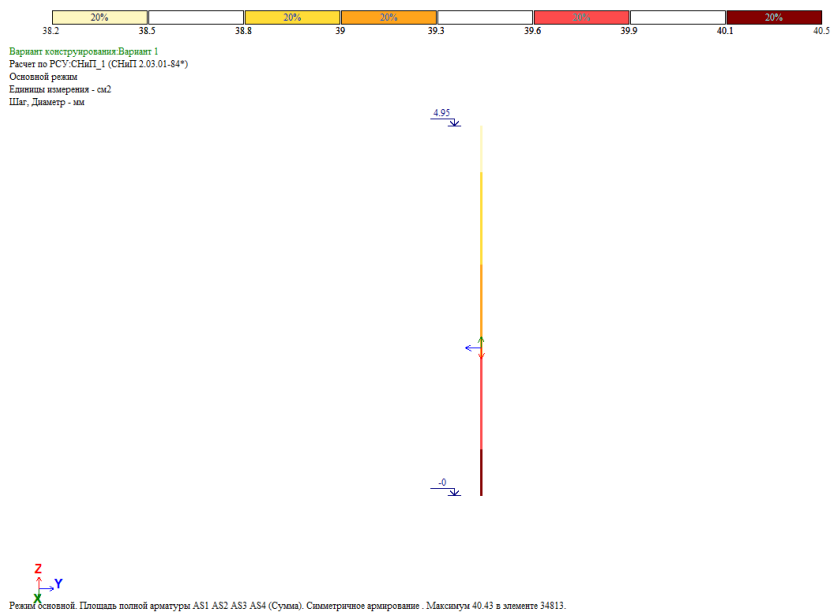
Фрагмент колонны по оси 2/в на отм. 0.000м до отм. 4.95 м (площадь полной арматуры, стержень 35944)
